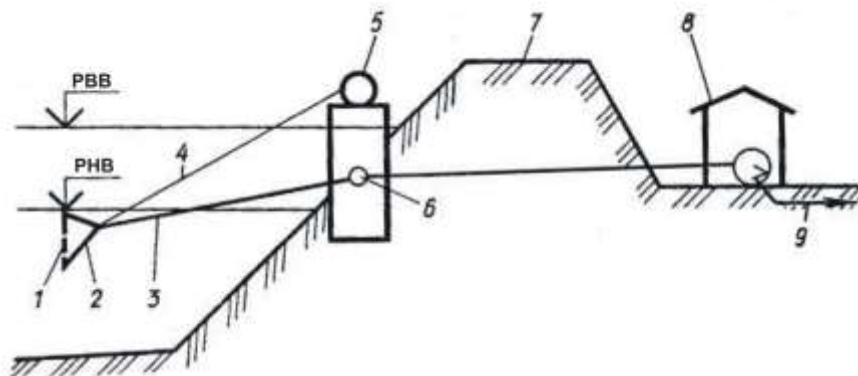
Пригребельний водозабір для потреб сільгоспводопостачання: 1 – сміттєзатримувальна решітка; 2 – розтруб; 3 – всмоктувальна лінія; 4 – трос; 5 – підйомний механізм; 6 – шарнірне з'єднання; 7 – гребля; 8 – насосна станція; 9 – напірна лінія
